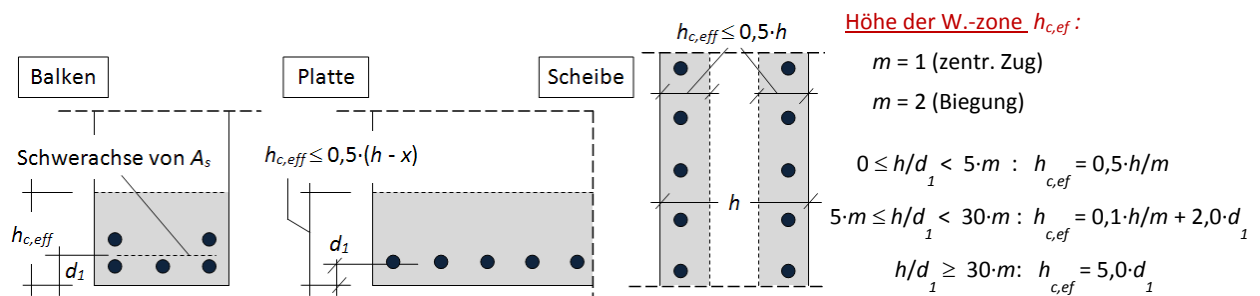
Wirkungsbereich bei Bauteilen unter Zugbeanspruchung
